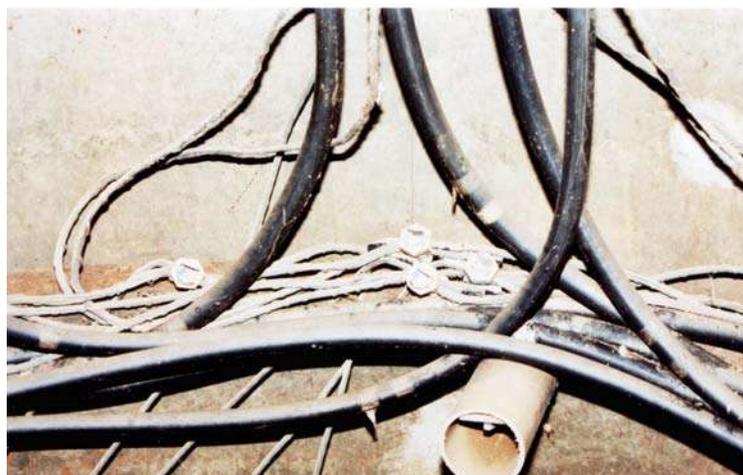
Detalhe da fixação dos cabos na caixa de inspeção
